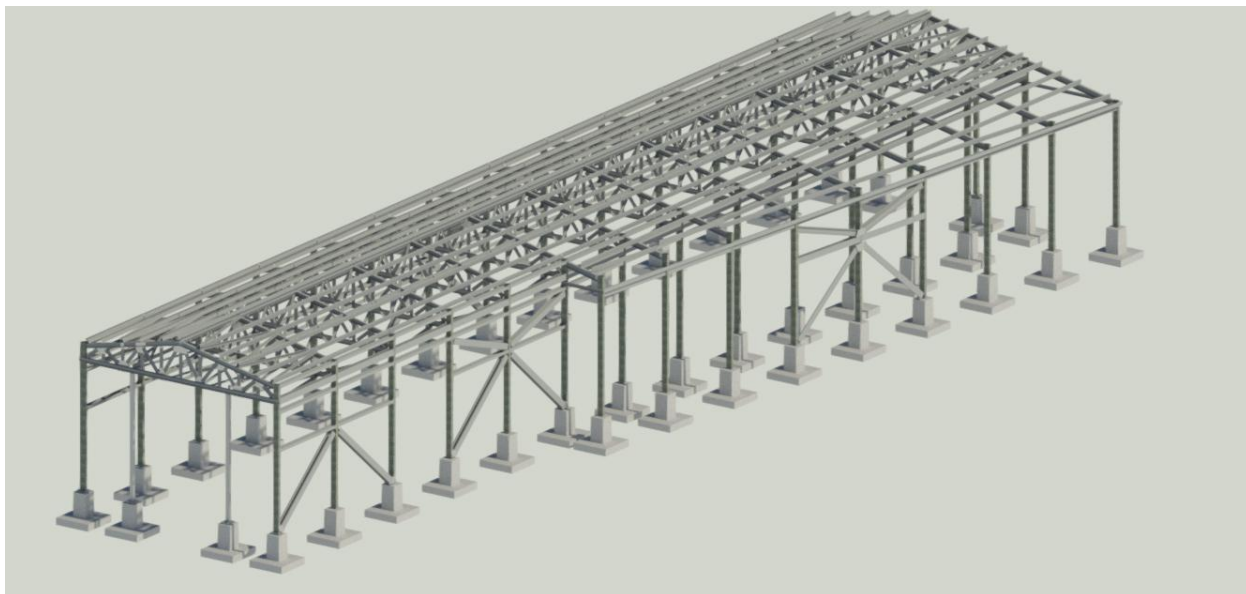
Раскладка допа и перекраска перекрытых КЭ
